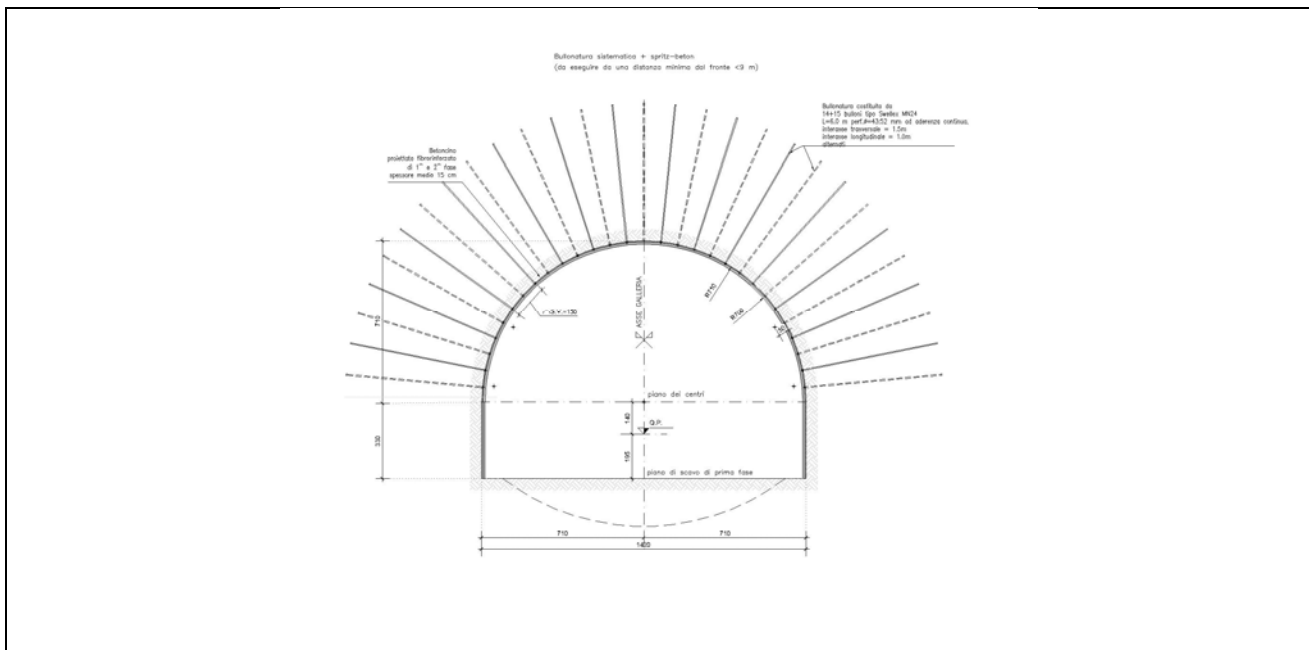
Sezione di scavo tipo GD -A1- Sezione trasversale
